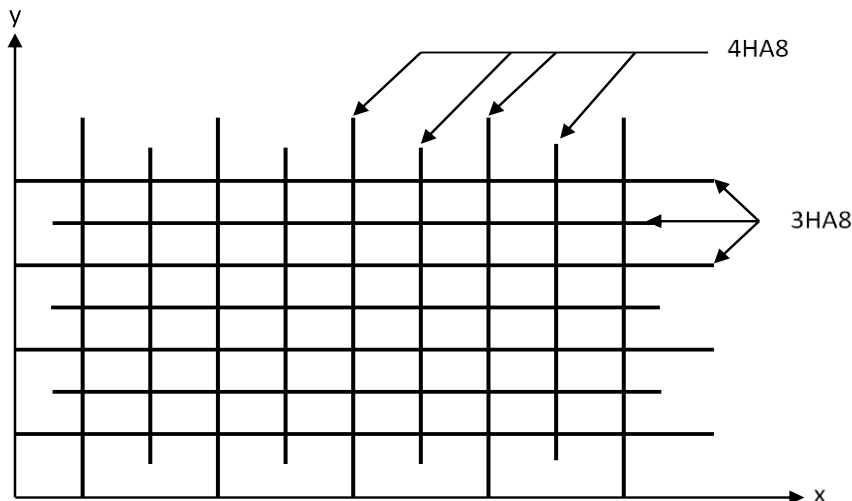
Schéma de ferrailage de la dalle sur 2 appuis
